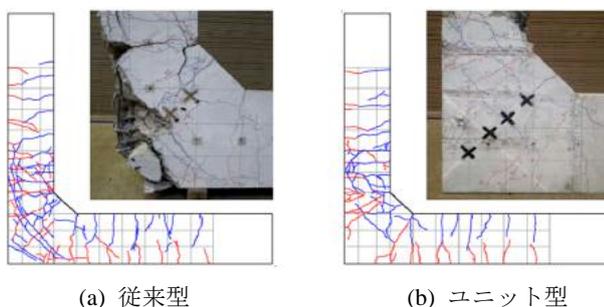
損傷状況とひび割れ発生状況<sup>3)</sup>
